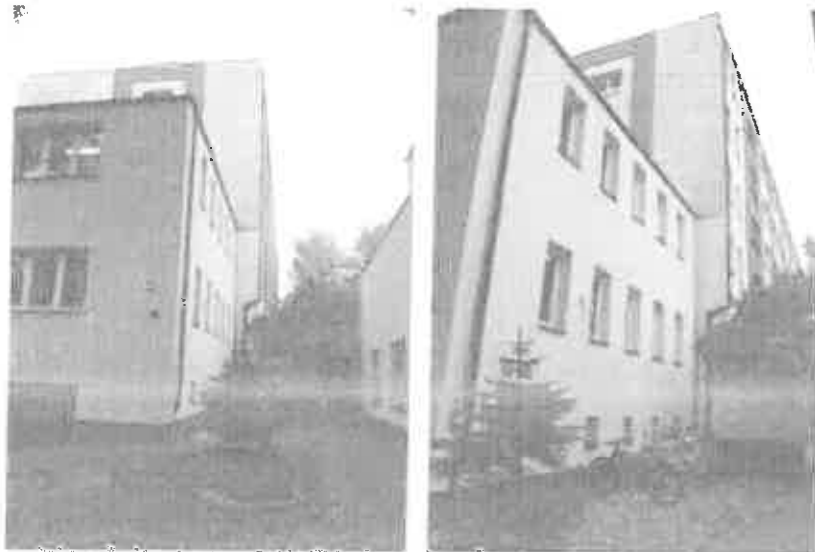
Budynek UM Inowrocław – segment B (Łącznik) – elewacja południowa
